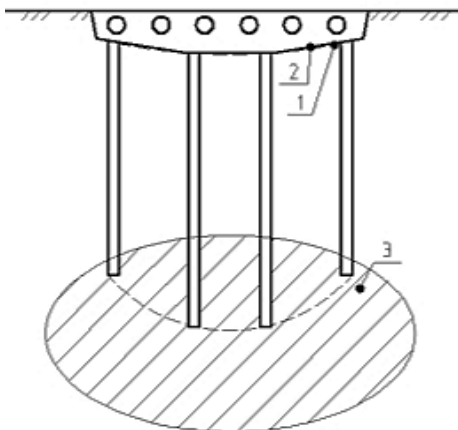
Расчётная схема фундаментов с криволинейной поверхностью опирания:
